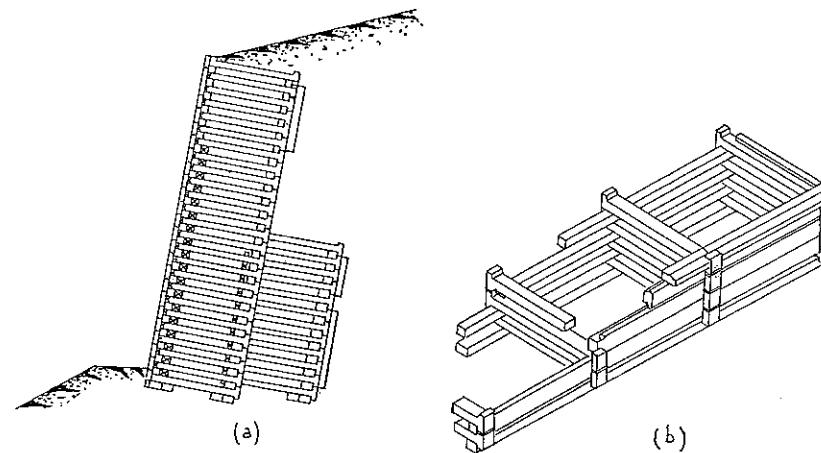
Murs de soutènement en éléments préfabriqués (cribwall)
